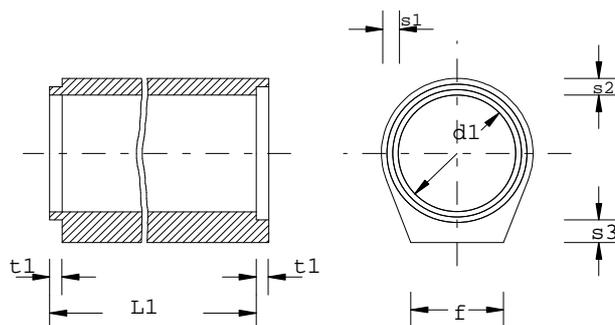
tubi in calcestruzzo di sezione circolare con giunto a risega e piede
